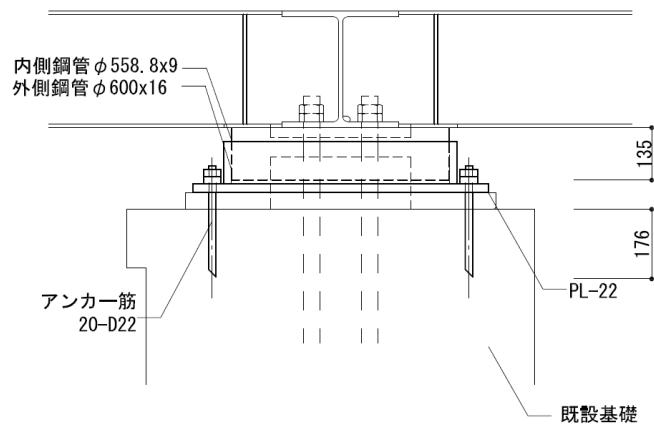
補強鋼管とあと施工アンカー詳細 (断面図)
